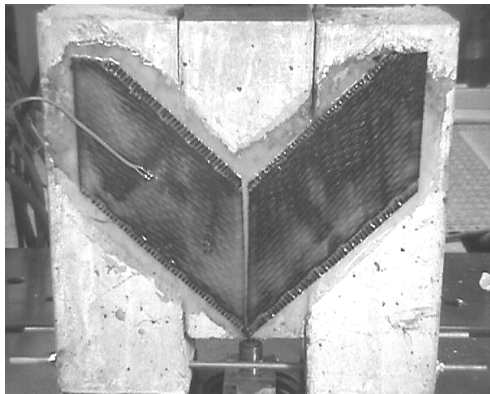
Ensayo tipo TRI-Unión 45° con las galgas adheridas sobre las fibras longitudinales.
